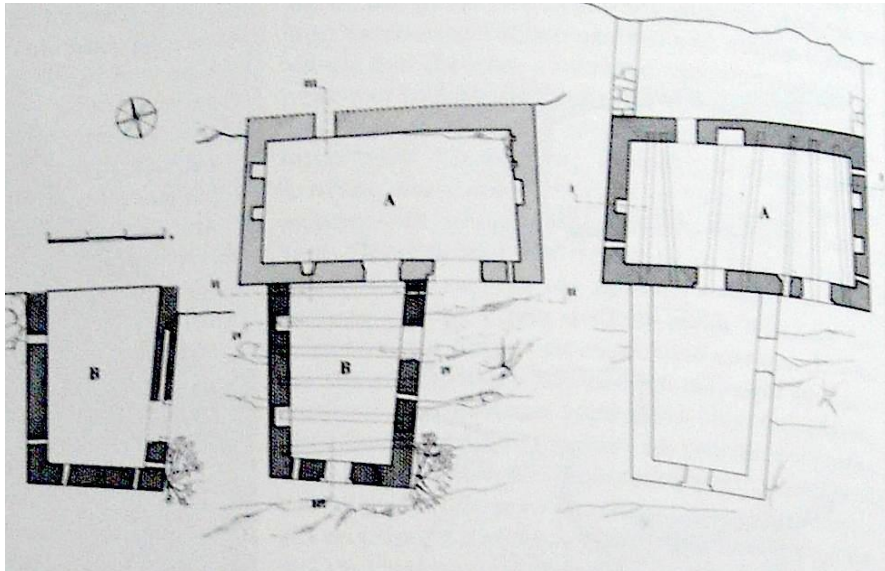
Geraki, Haus 2, Grundriss
